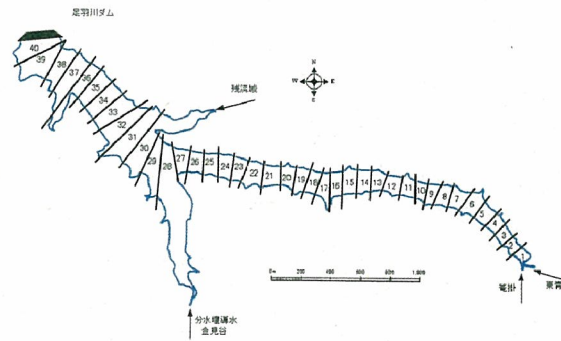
足羽川ダム洪水調節地の平面図
